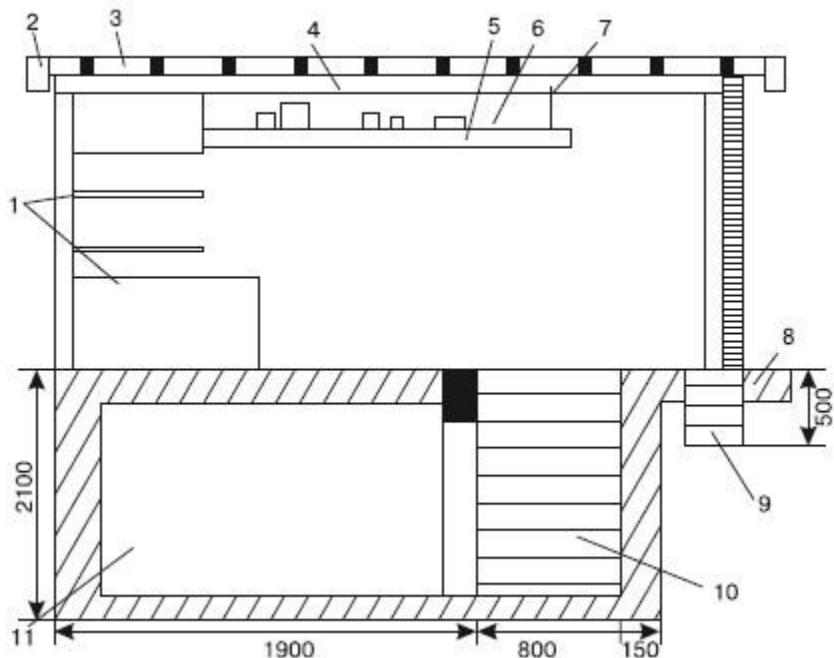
Оборудование гаража и поперечный разрез со смотровой ямой и подвалом: 1 – верстак с тисками и стеллажи (полки); 2 – облицовочная доска; 3 – рубероид; 4 – балка перекрытия; 5 – балка навесного потолка (антресоли); 6 – щит антресоли; 7 – петли навески антресоли; 8 – отмостка; 9 – фундамент; 10 – смотровая яма; 11 – погреб (подвал)
